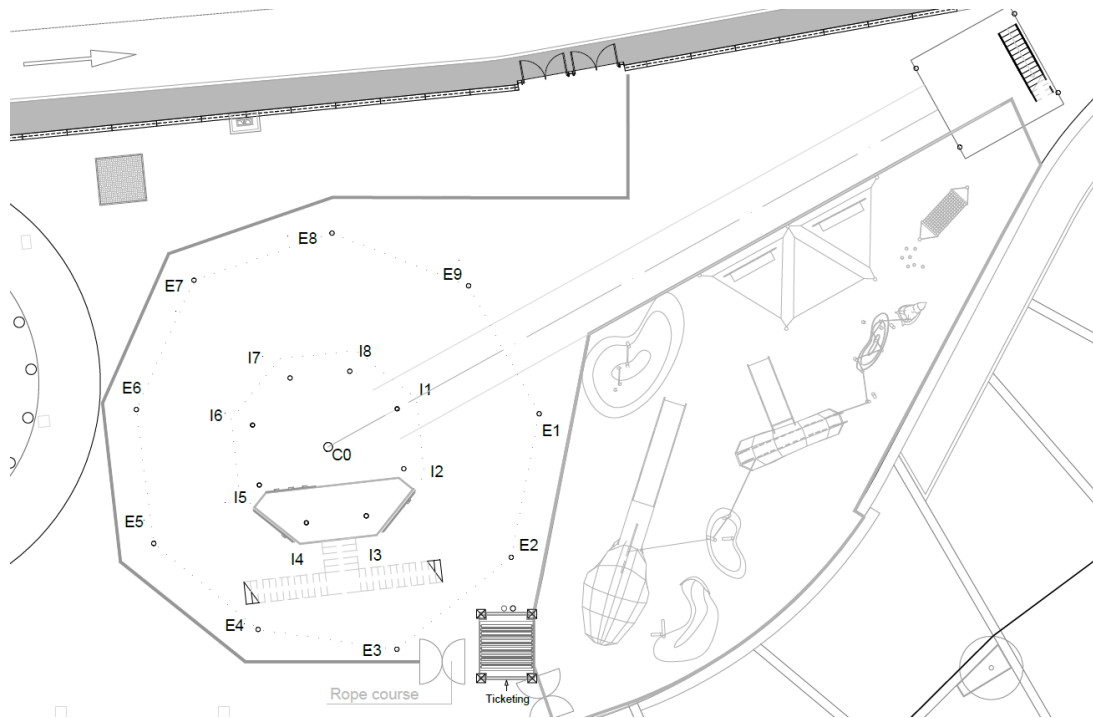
Planta general, situación de pilares. Fuente: Memoria de cálculo de la Torre Multiaventura
